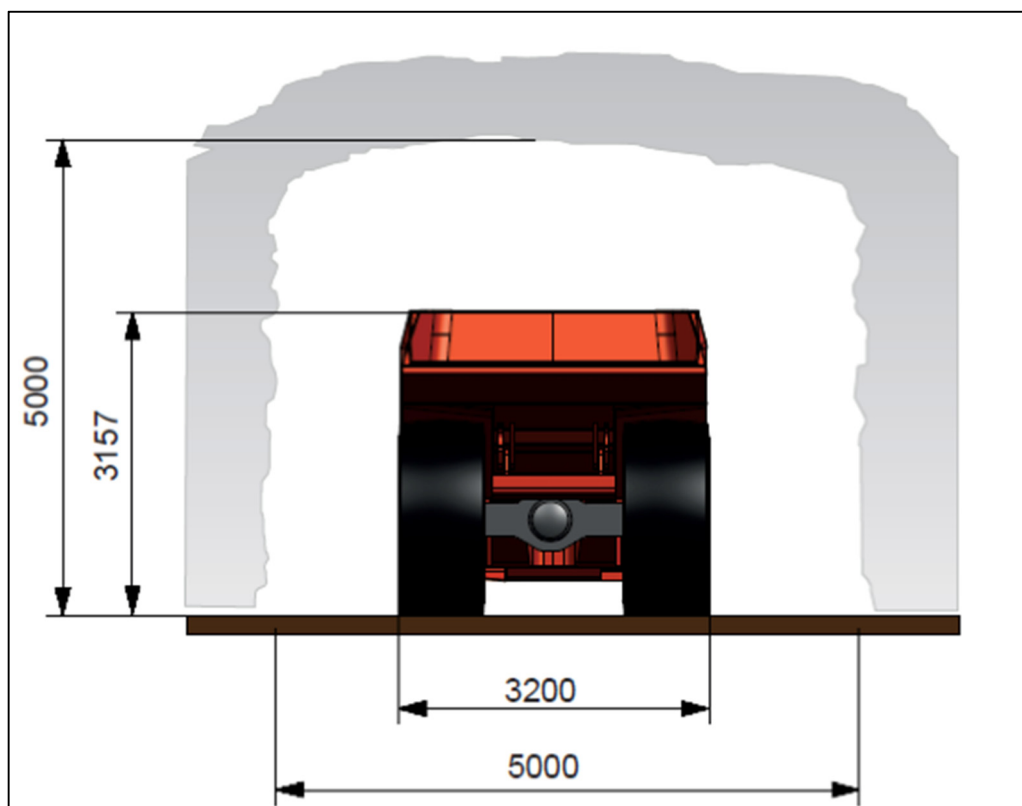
Dimensions du camion à benne articulé TH551i vue arrière
